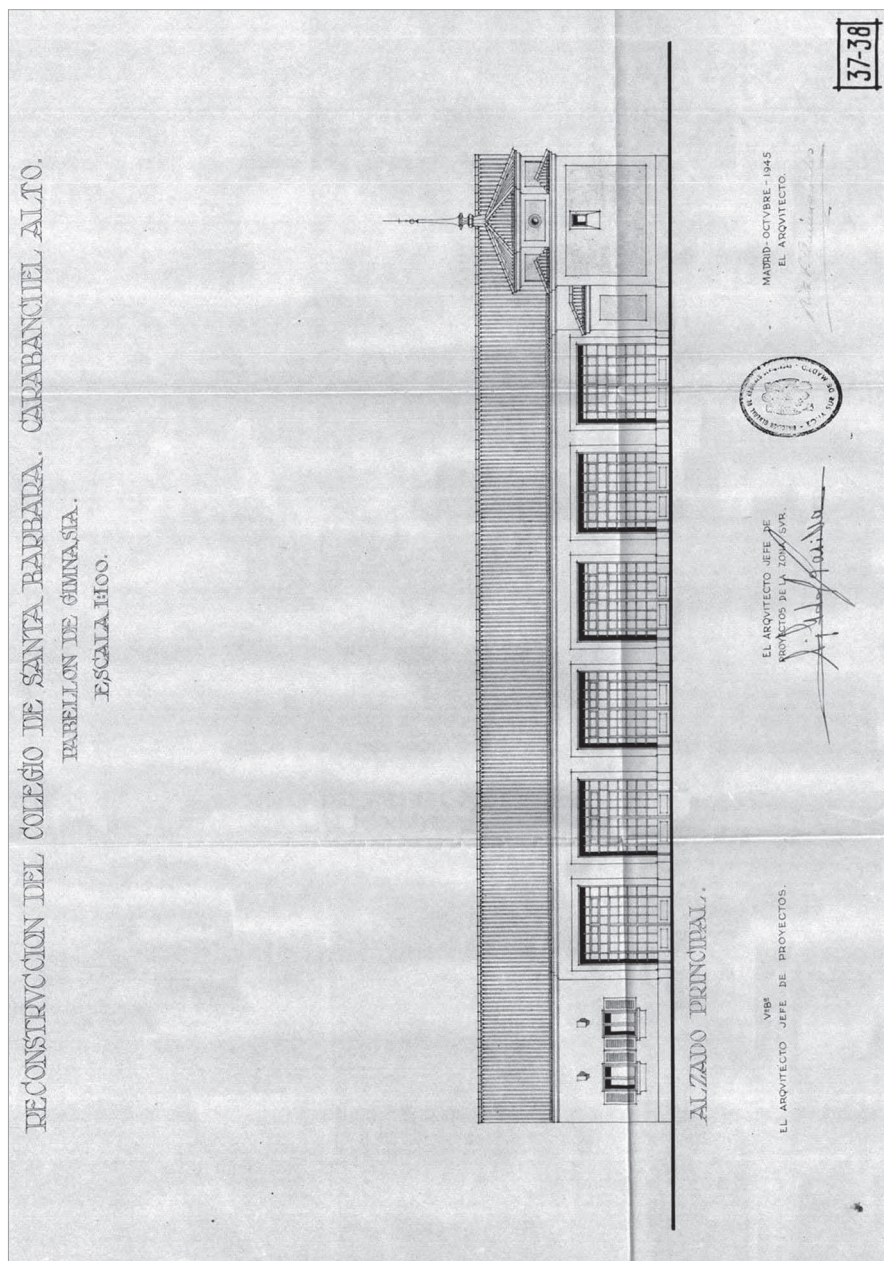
Colegio de Santa Bárbara. Carabanchel Alto. Alzado del Pabellón de Gimnasia, 1945. AGA, (4) 81. Caja 4179 TOP 76/03-12; (2) 81.03 2576 TOP 76/04.
